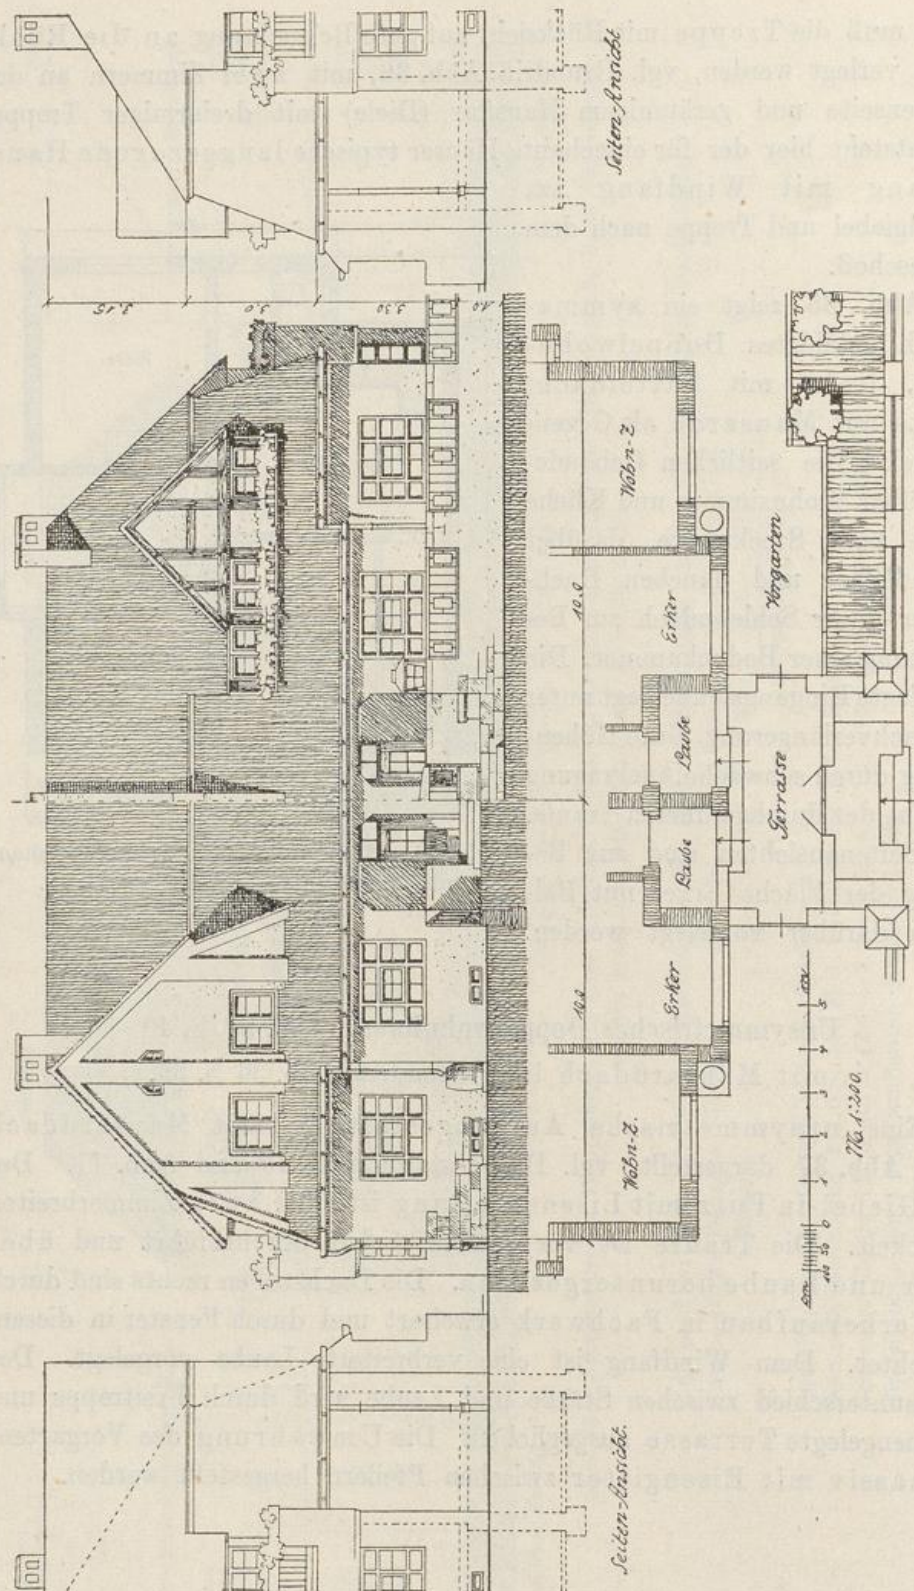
Unsymmetrisches Doppelhaus mit Mansarddach, Giebel und Dachkeraufbau. Hierzu Grundriß Abb. 36 S. 39.
